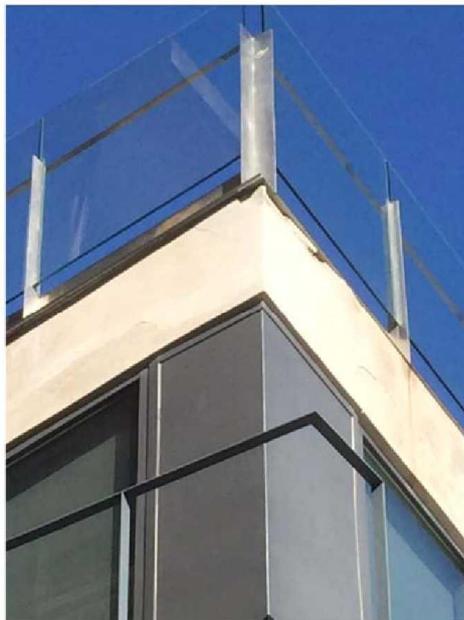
Se observa el desconchado en fachada del edificio nuevo.
